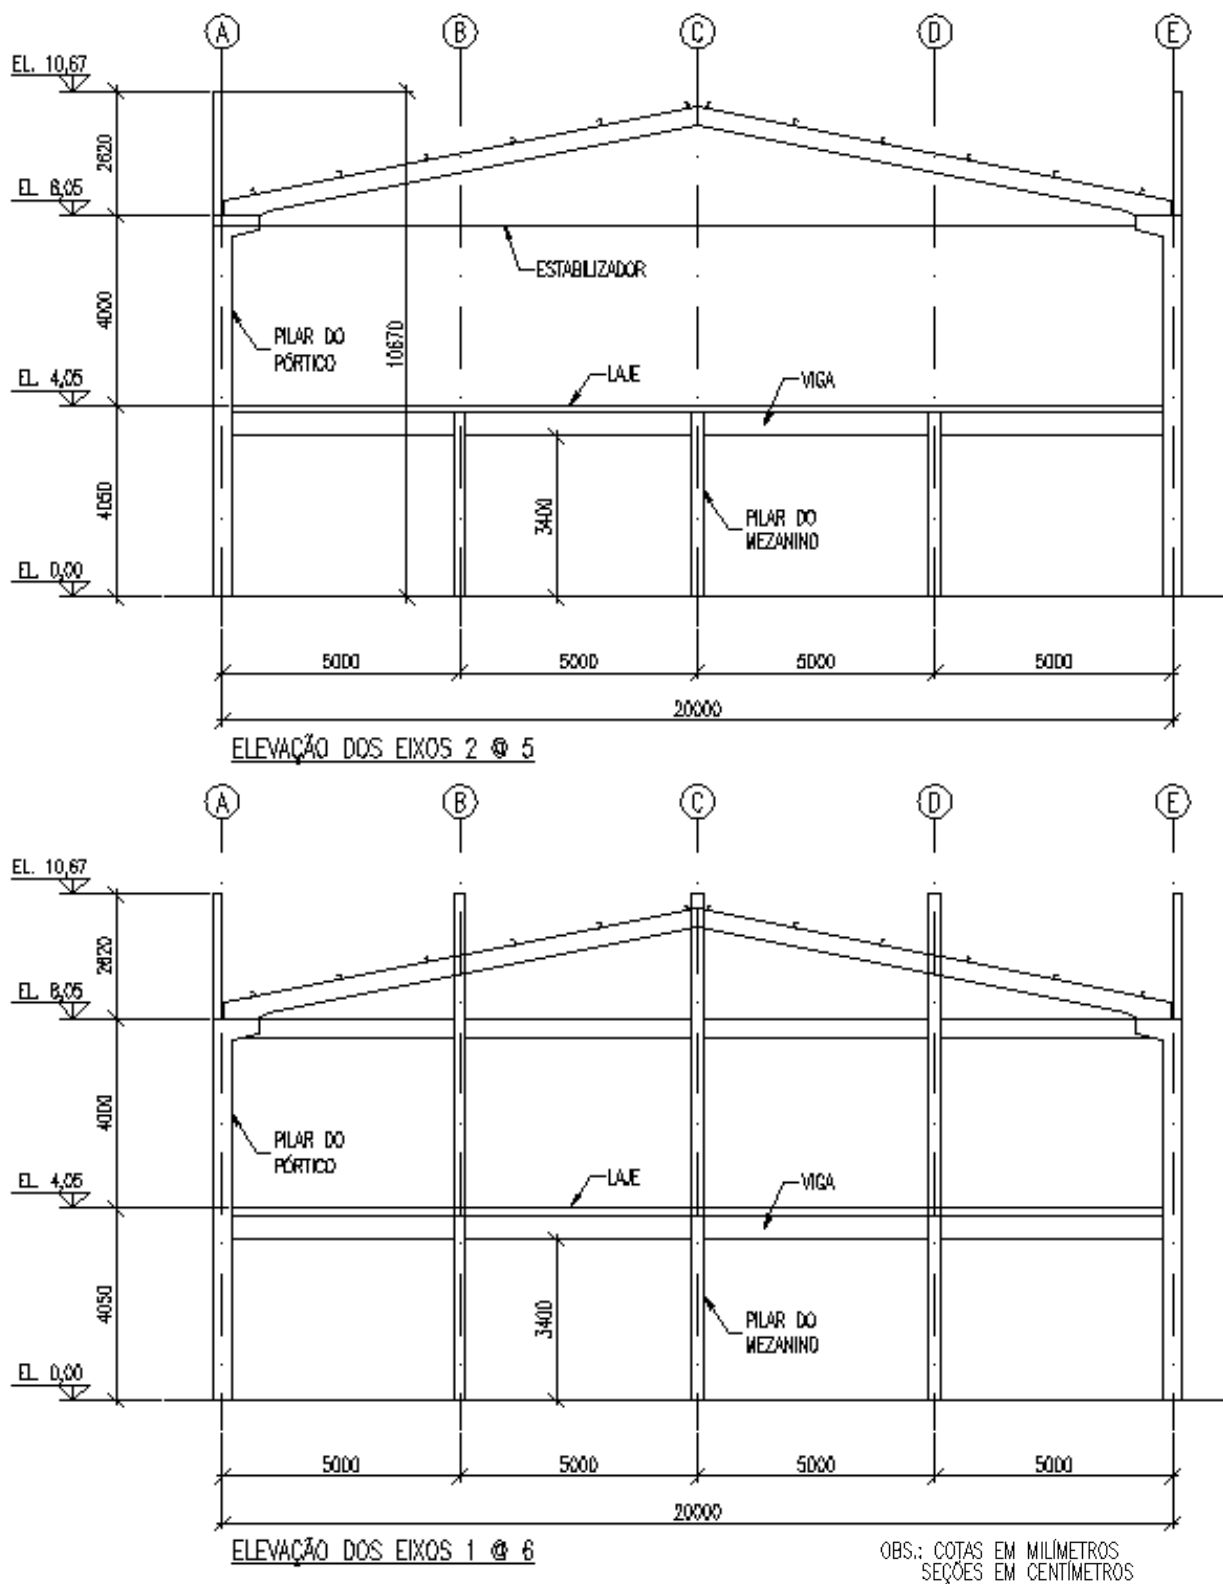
Elevações transversais da edificação para estrutura em concreto pré-moldado.
